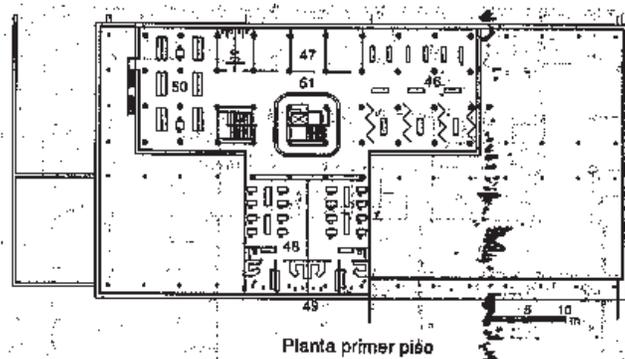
Planta de la Biblioteca Central. Juan O' Gorman.
